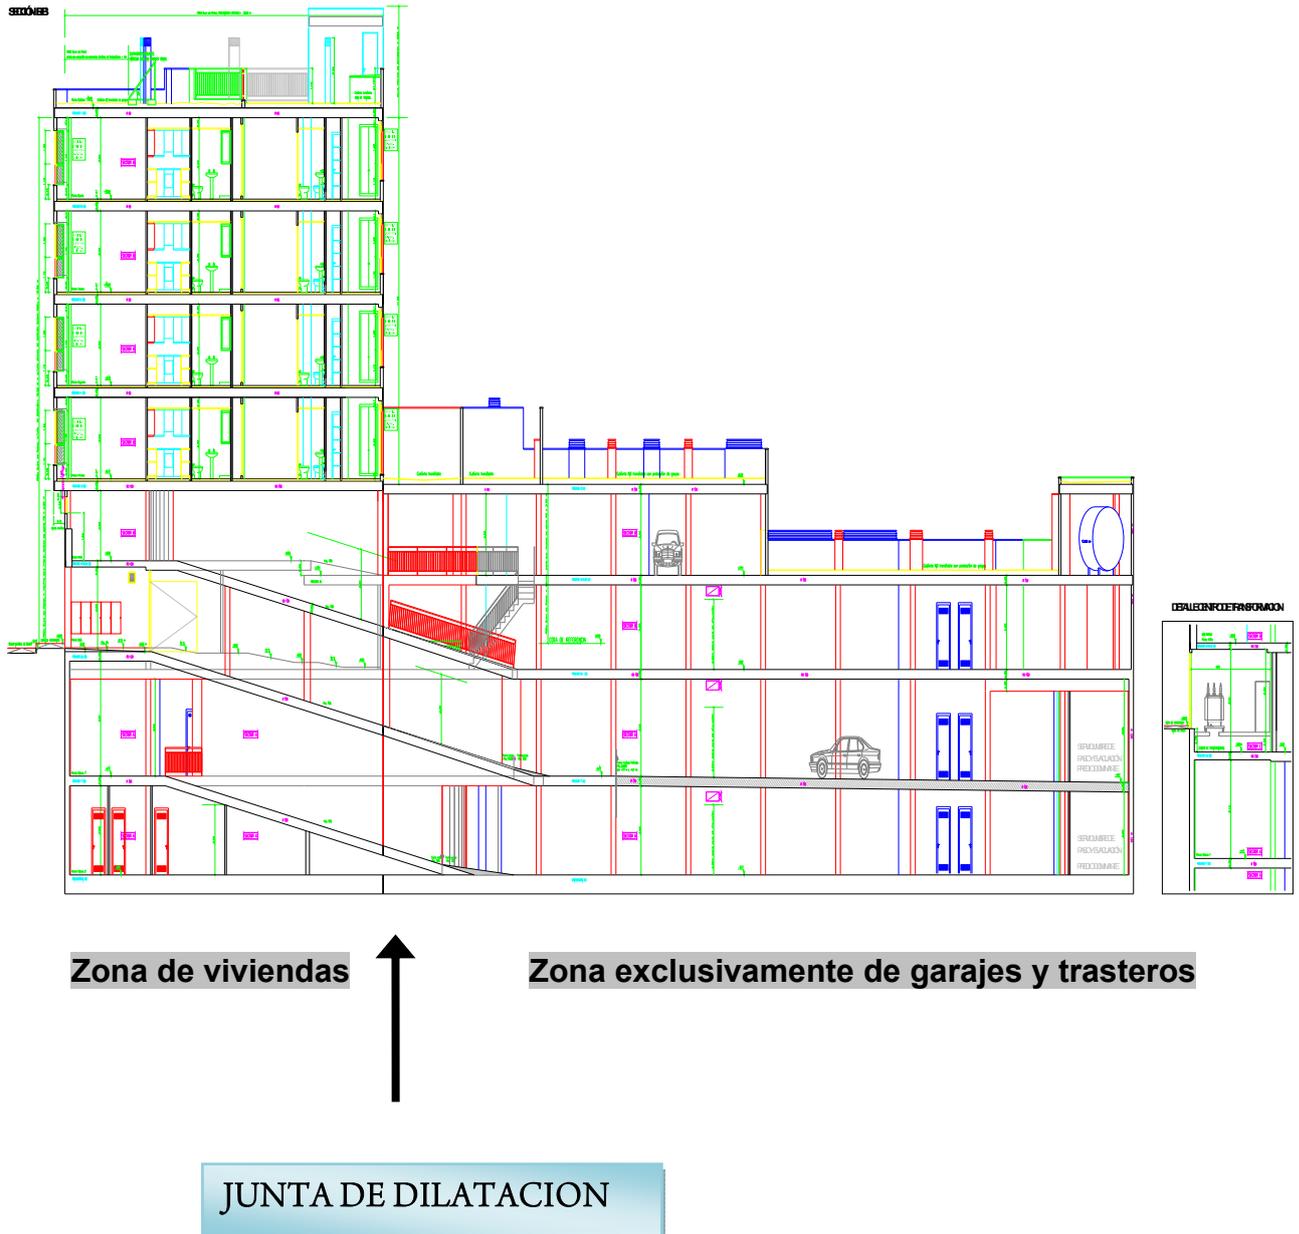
Sección donde se aprecian claramente las dos zonas de la fase B, separadas por una junta de dilatación.
